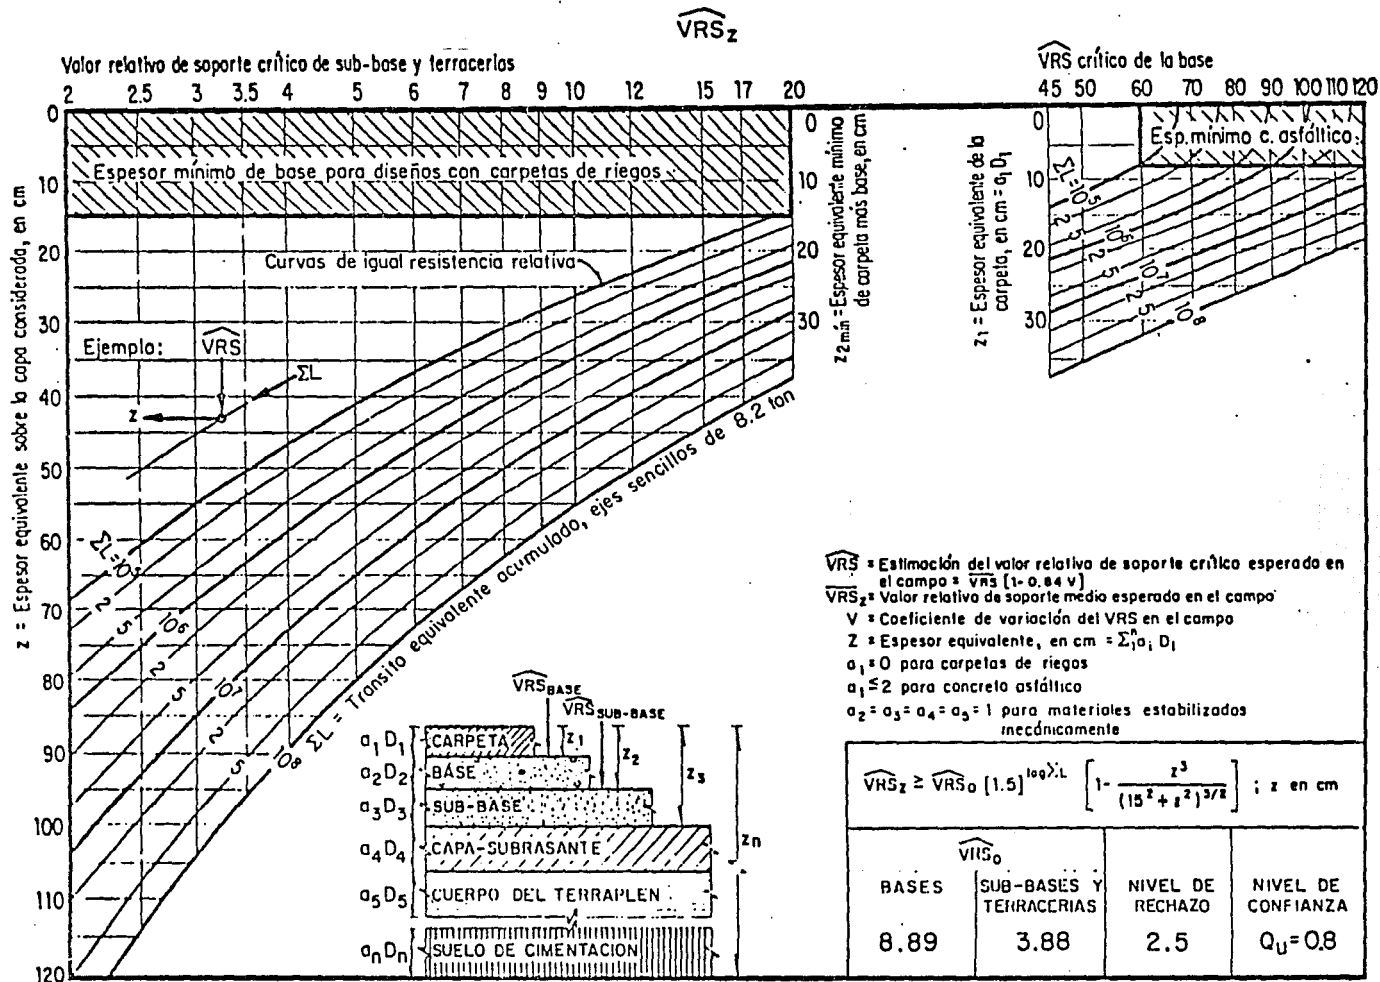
Gráfica para el diseño estructural de carreteras con pavimento flexible
